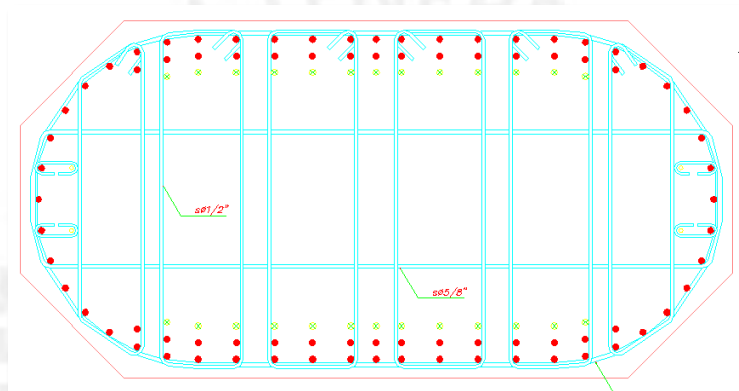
Pilares centrales con 82φ1" y 2 estribo 5/8" + 10 estribos 1/2".
